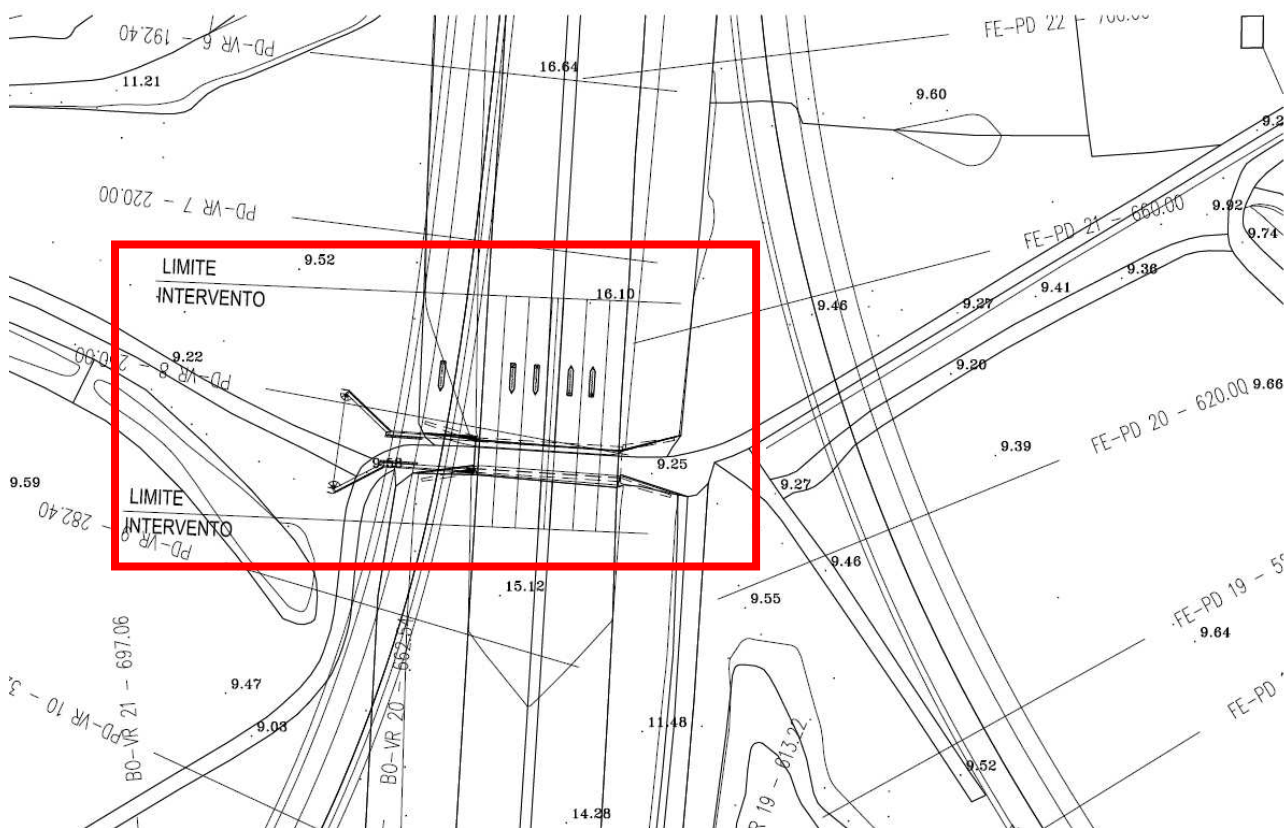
PLANIMETRIA SOTTOPASSO
